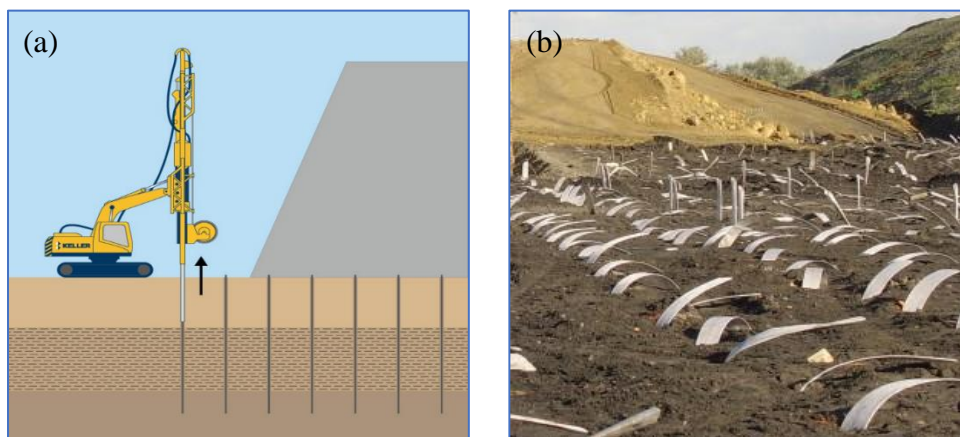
Drains verticaux : (a) installation ; (b) drains installés (d'après : Keller-na ; Geotechnicsworld).
